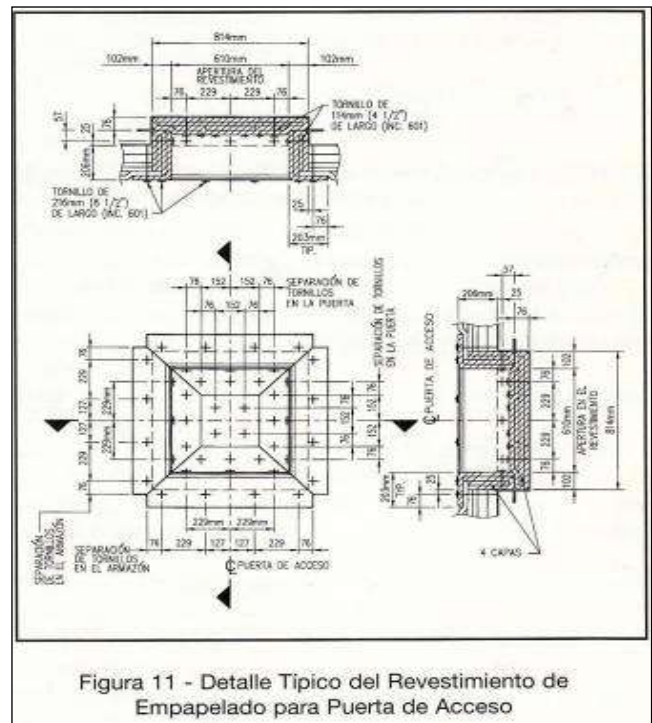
Detalle Típico del Revestimiento de Empapelado para Puerta de Acceso
